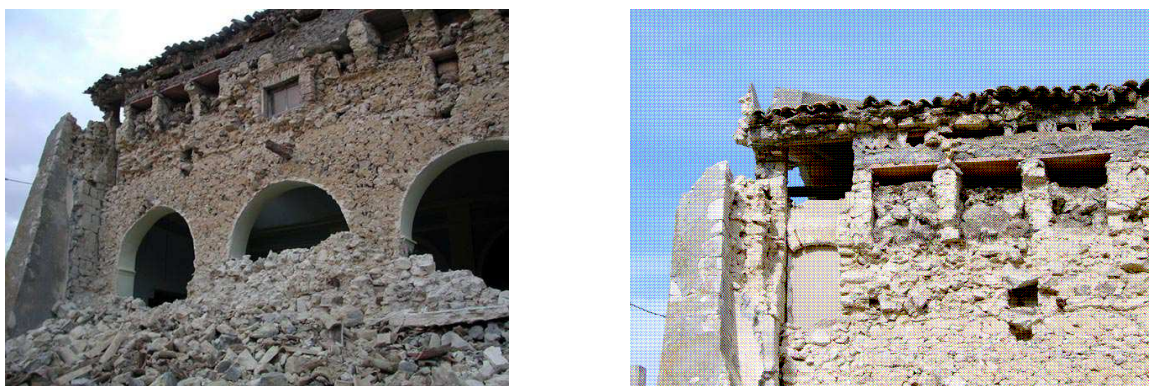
Detalle del refuerzo con hormigón armado. (Lagomarsino et al., 2004).
